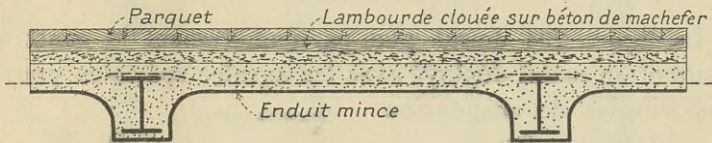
Poutrelles en fer et hourdis en béton armé.
